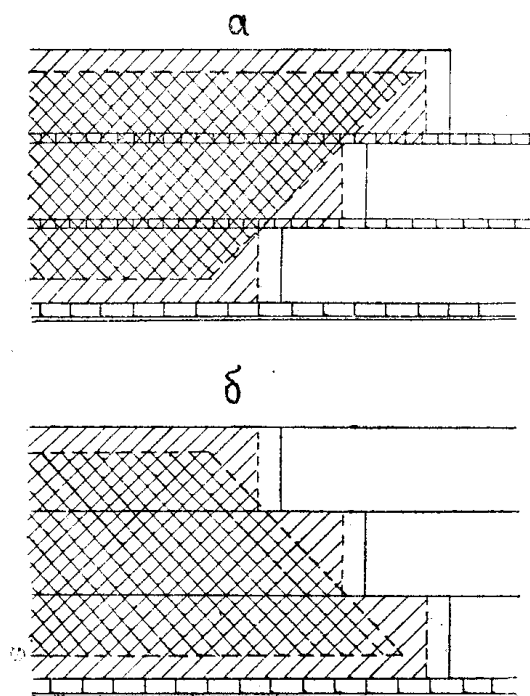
Схема распределения уплотненной закладки при разработке пластов длинными столбами по простиранию с закладкой: а — нисходящий порядок выемки подэтажей; б — восходящий порядок выемки подэтажей
